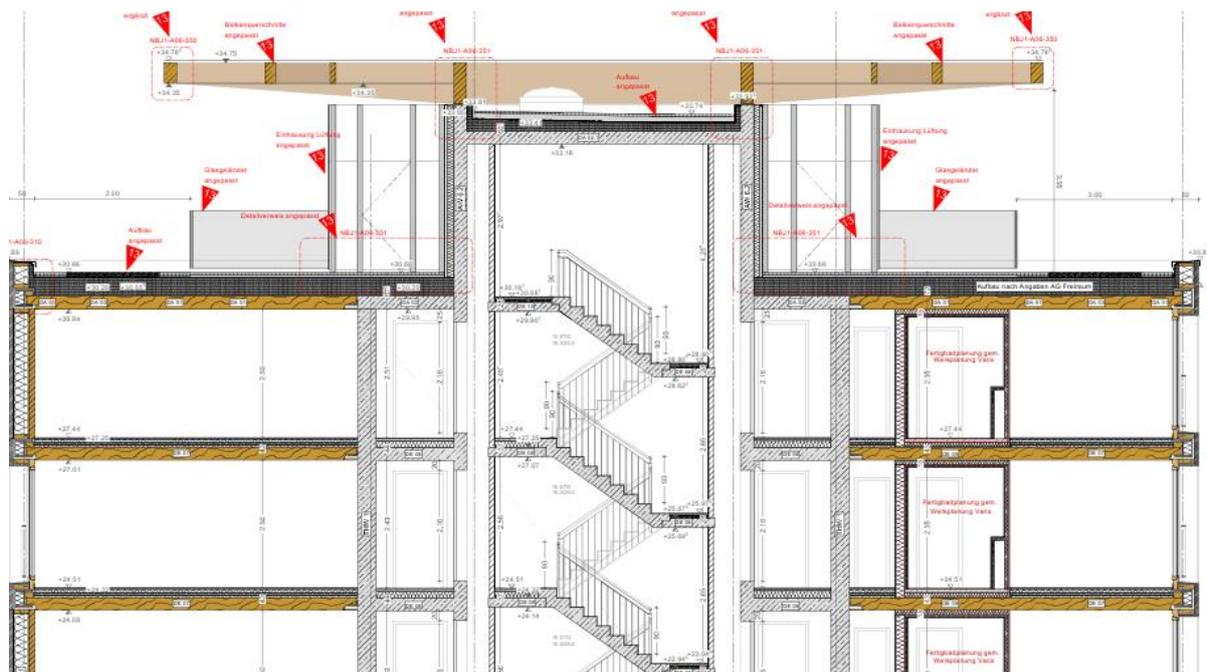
Gebäudeschnitt (Quelle: Kaden und Lager, Berlin)
